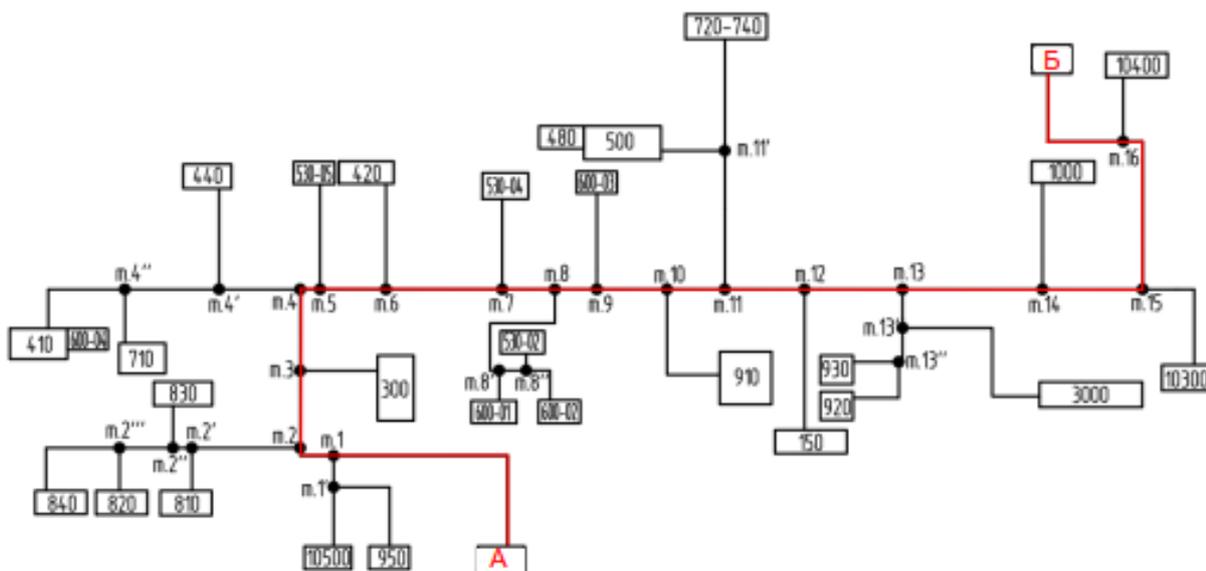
Расчетная схема трубопроводов теплофикационной воды
